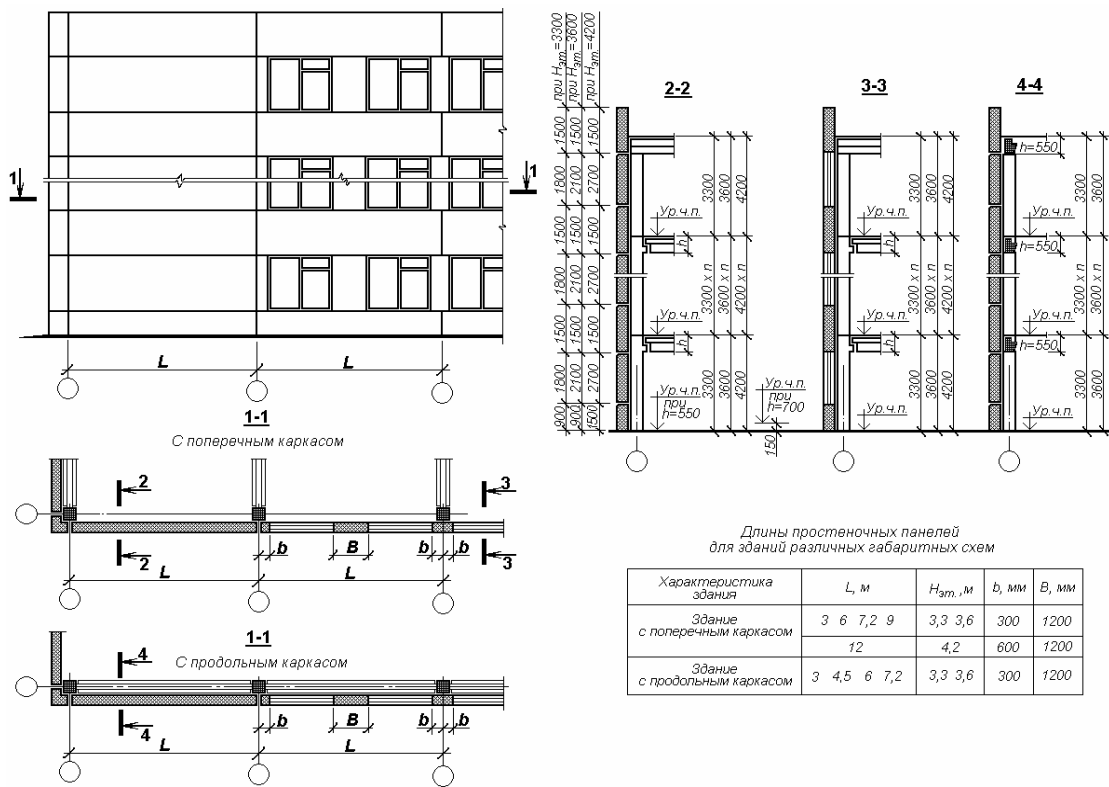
Схемы разрезки и компоновки панелей наружных стен.
